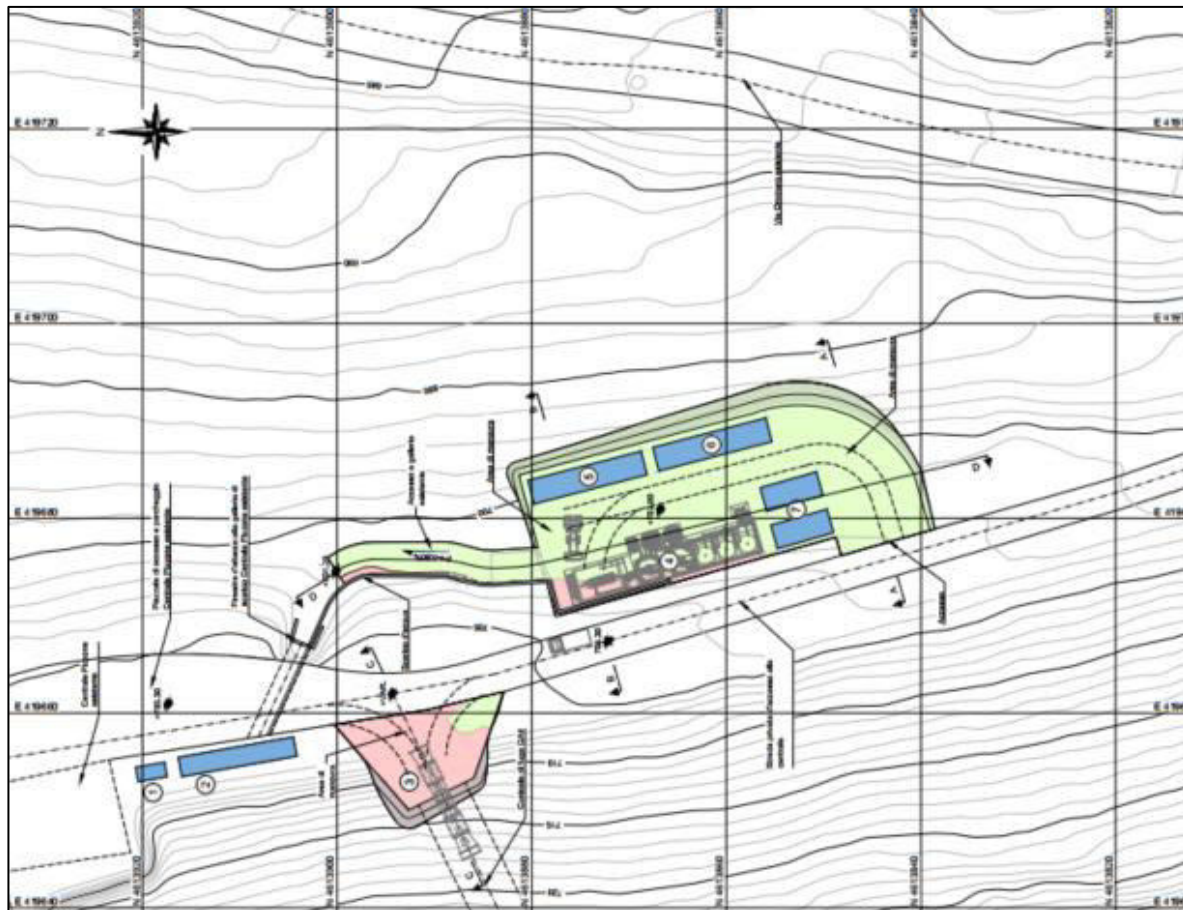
Ambito Pizzone - Area di cantiere CA.GA4 – Cunicolo di fuga della centrale
